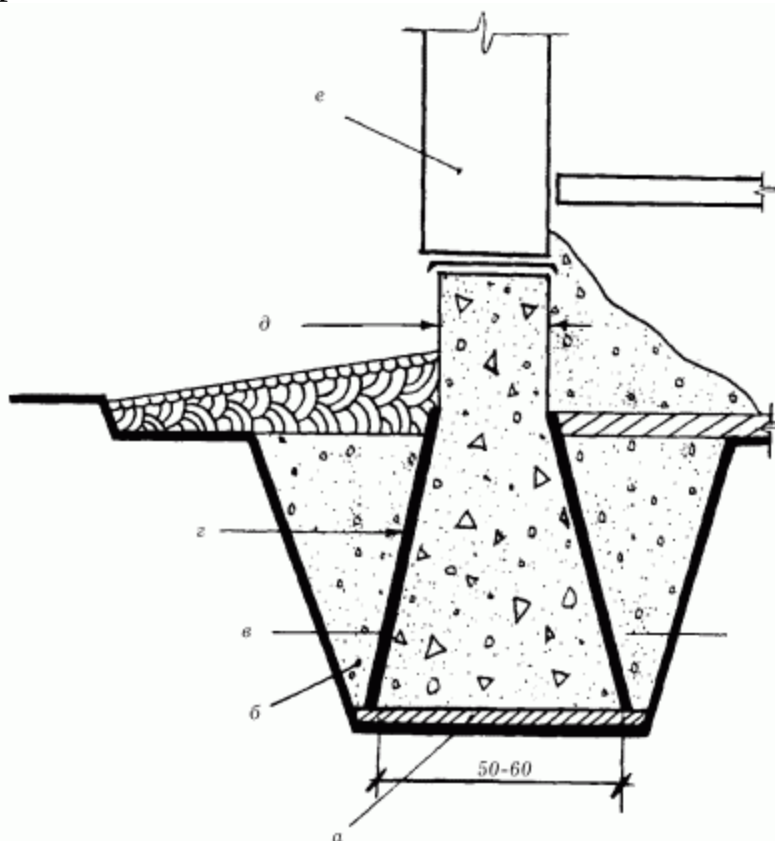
Устройство бетонного или бутобетонного фундамента в условиях тяжелых грунтов: а – уплотненный грунт или щебень; б – обратная засыпка; в – глубина промерзания грунта; г – обмазка; д – бетон или бутобетон; е – каменная стена.
